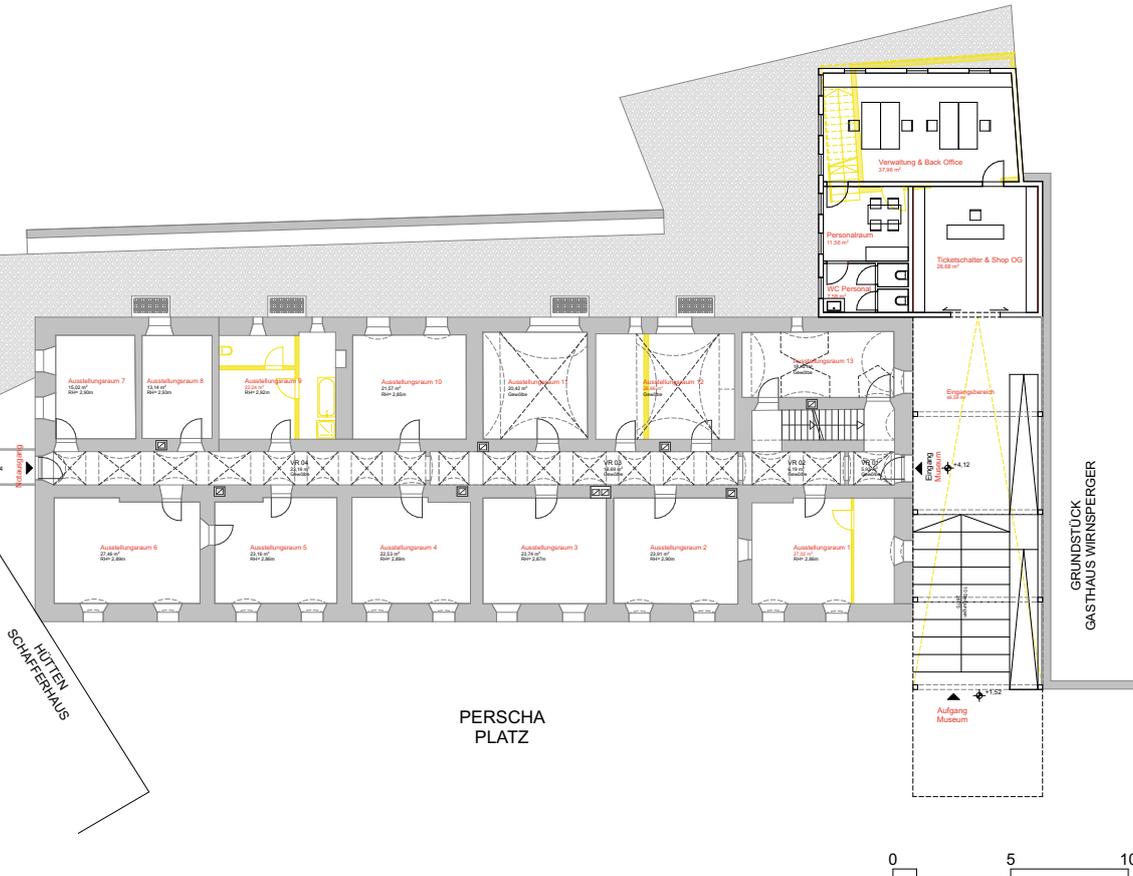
Entwurfsplan Obergeschoss Antoni Grubenhaus
